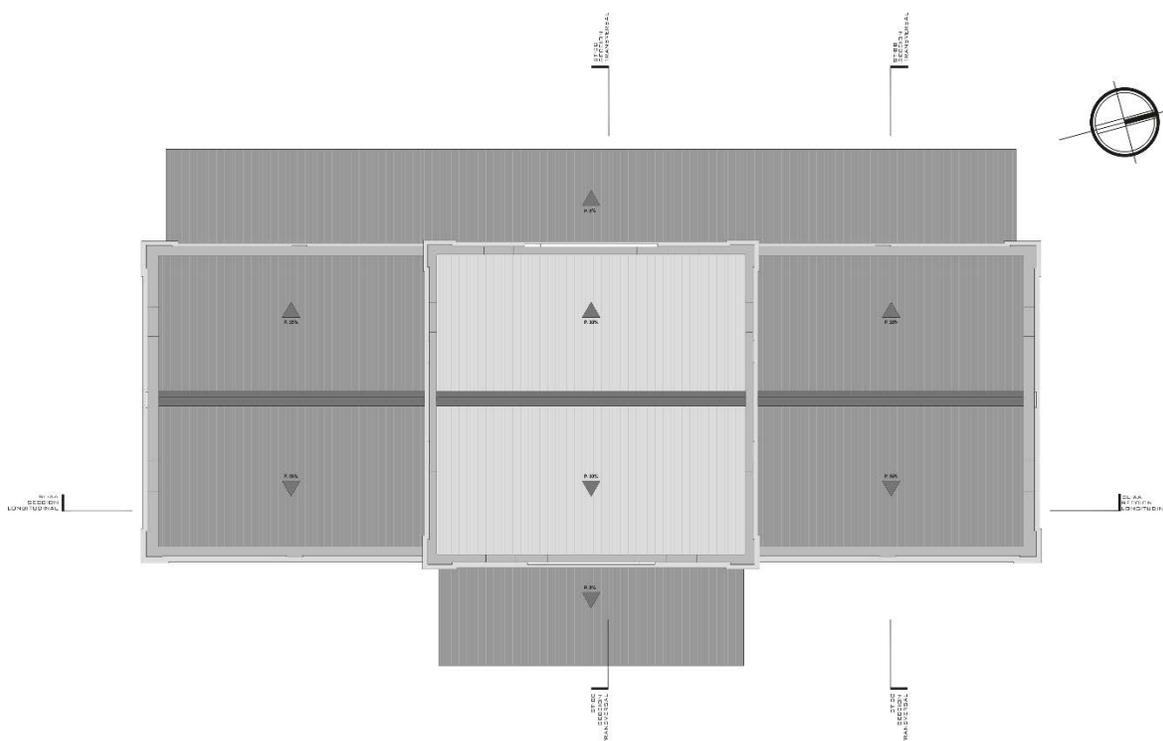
Planta de cubiertas, Estación del ferrocarril Sur.
